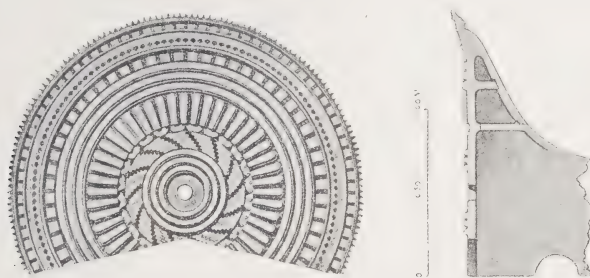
Acroterio dello Heraion d'Olimpia; prospetto e sezione.
